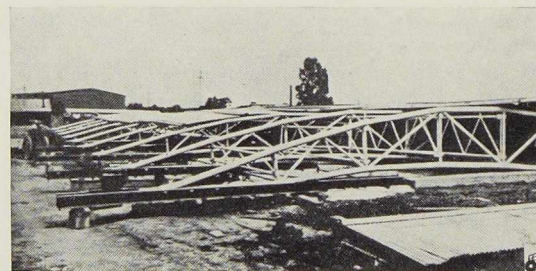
(en bas). Charge de toiture pour hall en tubes soudés
